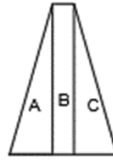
Divisão do muro em secções para facilitar o peso próprio do muro
